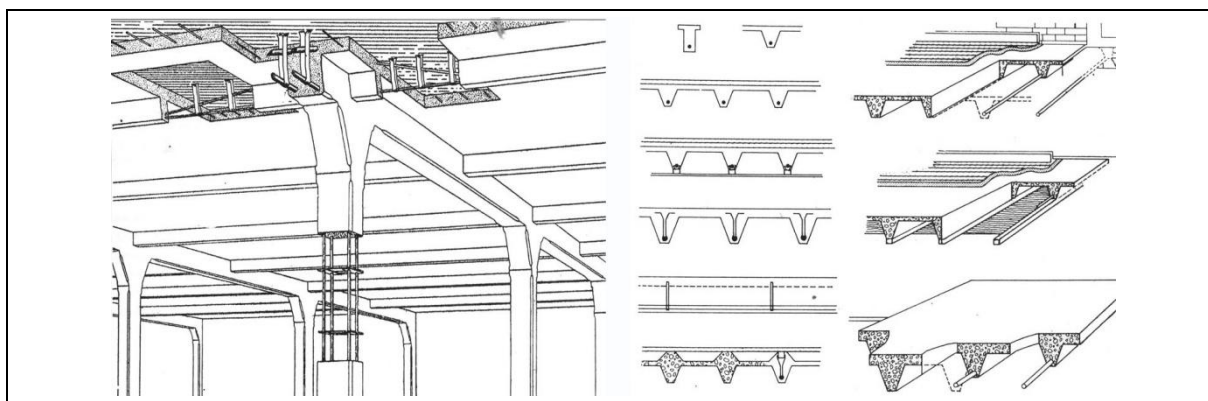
Sistema de uniões rígidas em betão armado de Hennebique [3]
